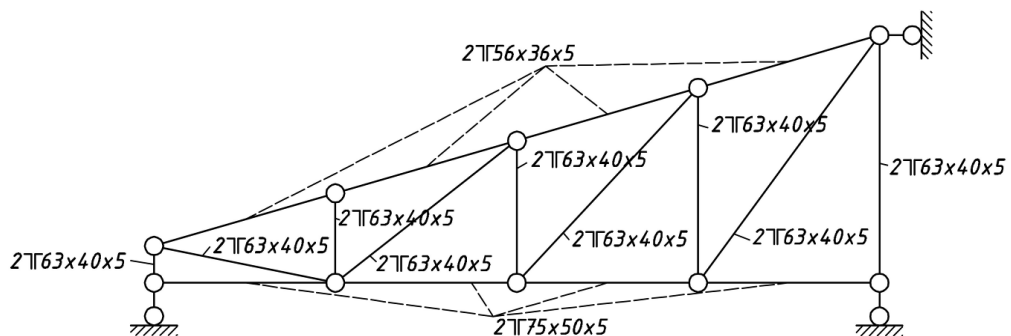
Калибры уголков поперечных сечений фермы
